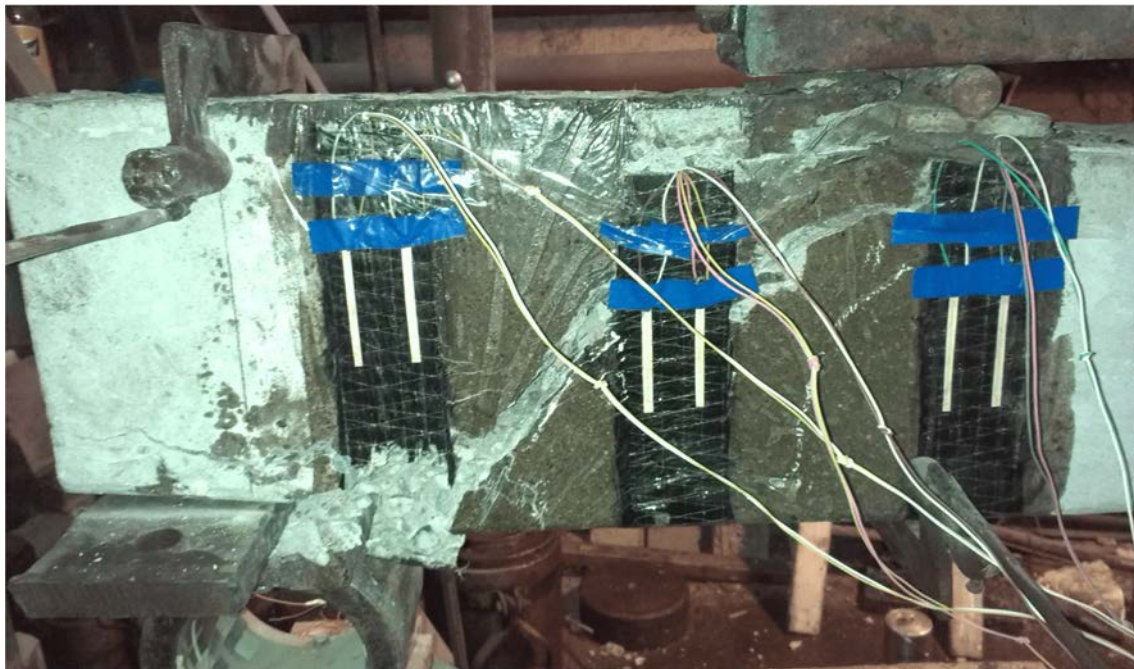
Участок разрушения балки, армированной вертикальными полосами из фиброармированной сетки
